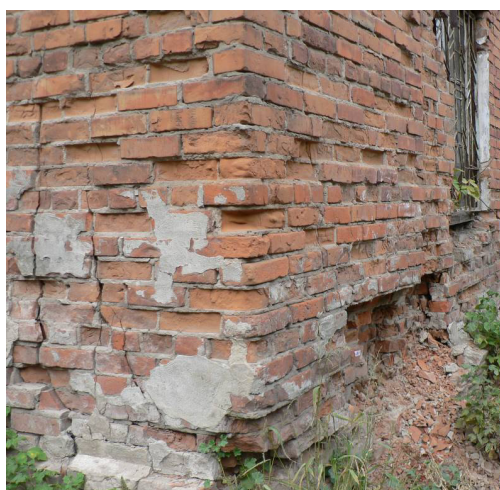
Разрушение кладки стены по оси 8 в уровне цоколя
